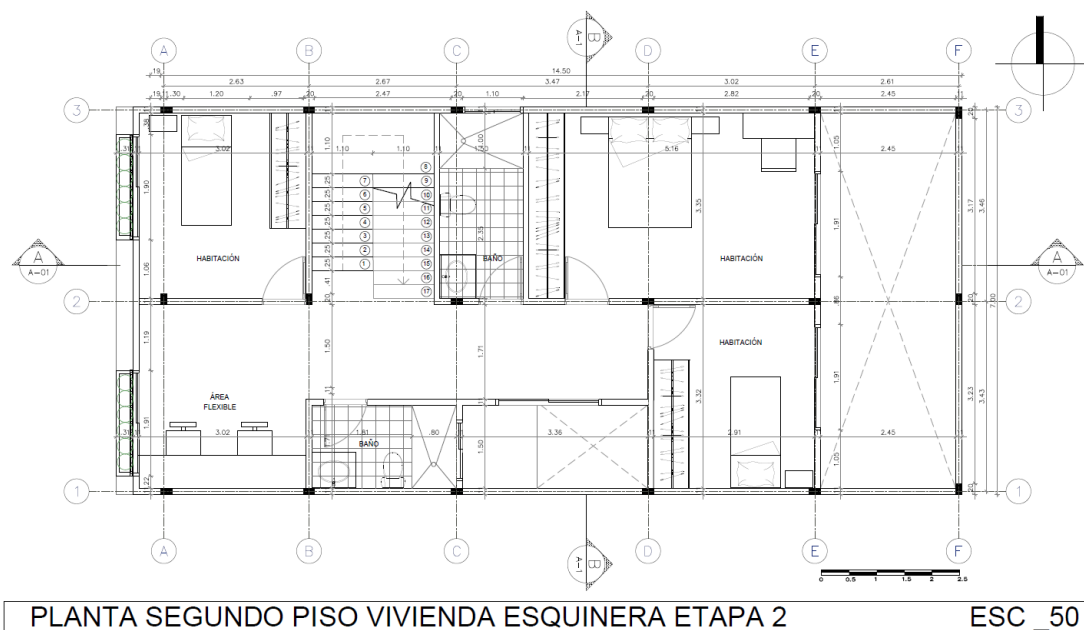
Vivienda en etapa 2 planta primer pisoFigura 92. Vivienda en etapa 2 planta segundo piso
